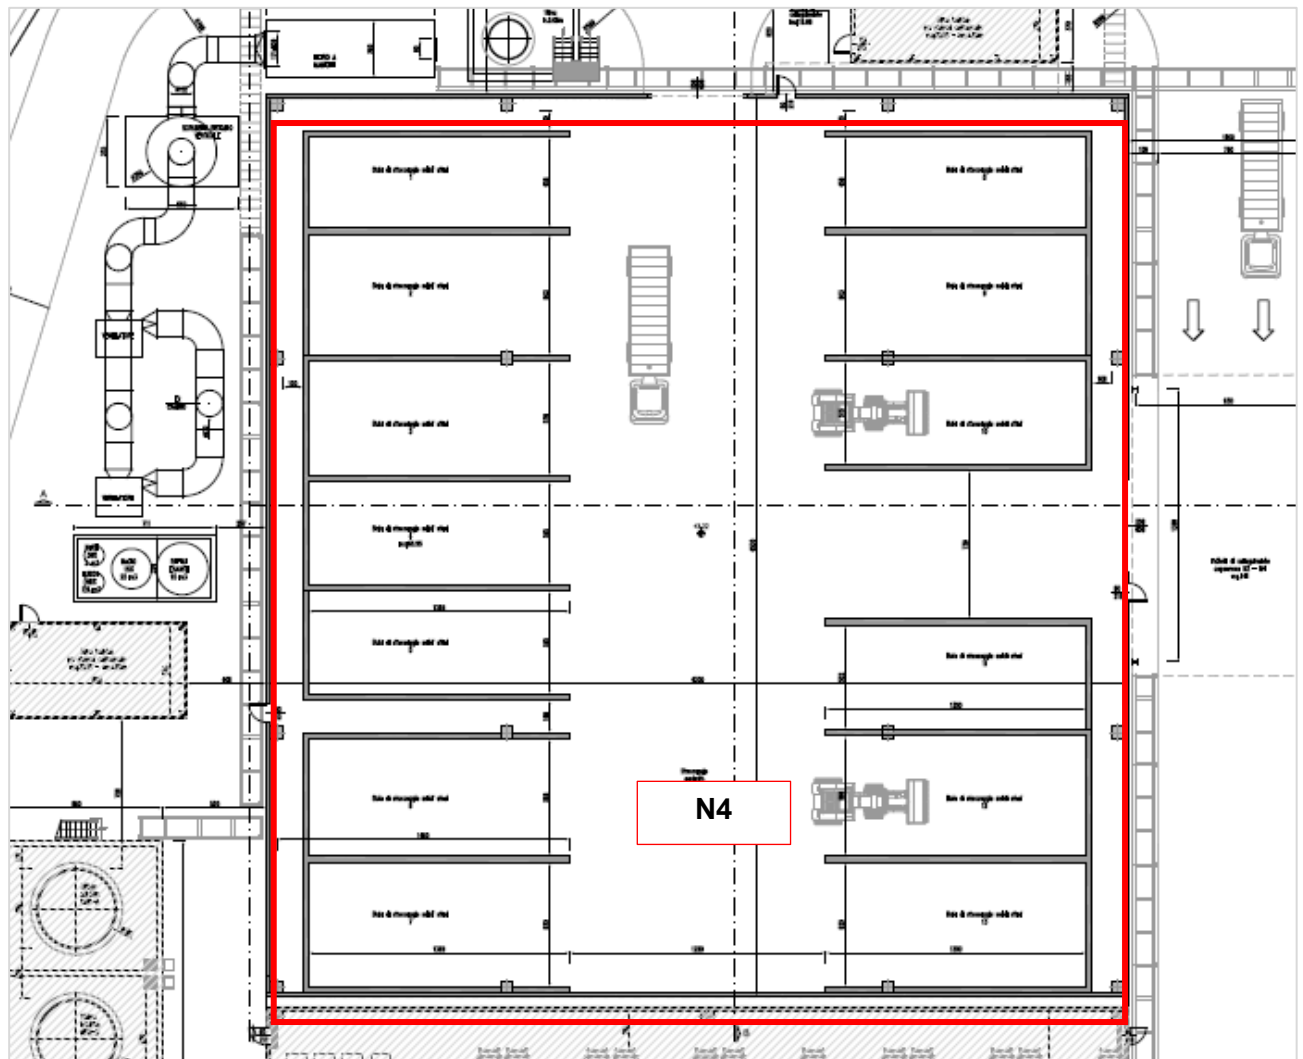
Dettaglio localizzazione Sezione N4 (Stralcio elaborato CO 05 RA VA 01 D1 PL 60.00 - N4 PIANTE)
